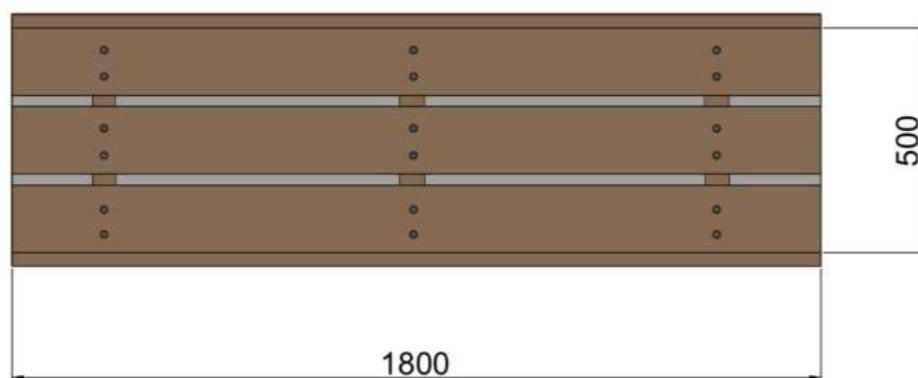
Technický detail - vyhlídka, zdroj: autor práce
